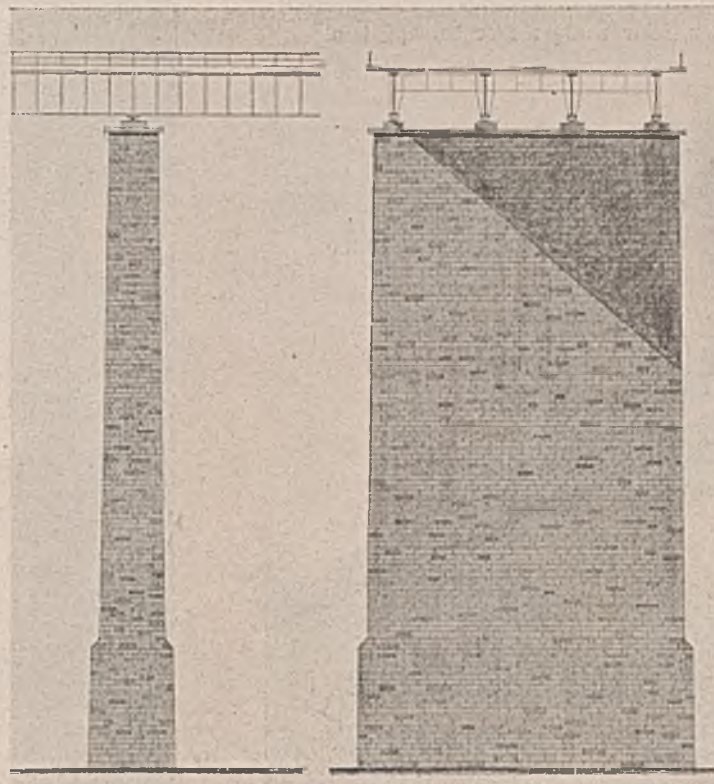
Hoher Pfeiler einer Talbrücke mit Kopfgesims und Sockel.
